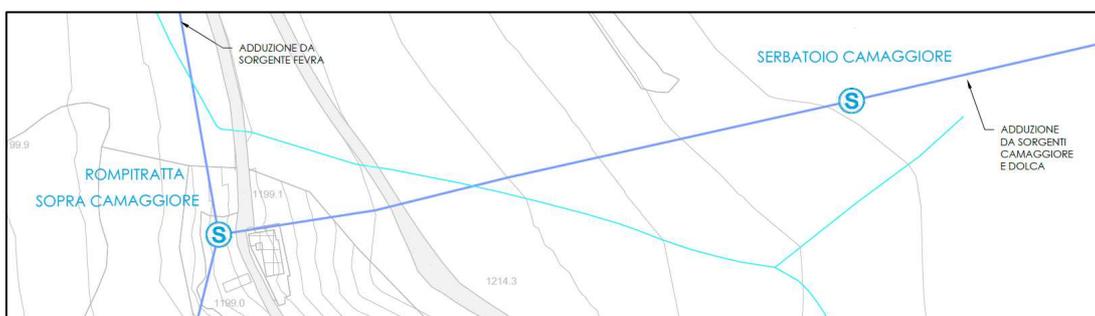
Stralcio planimetrico dello stato di fatto tra il serbatoio Camaggiore ed il casello rompitratta sopra Camaggiore
